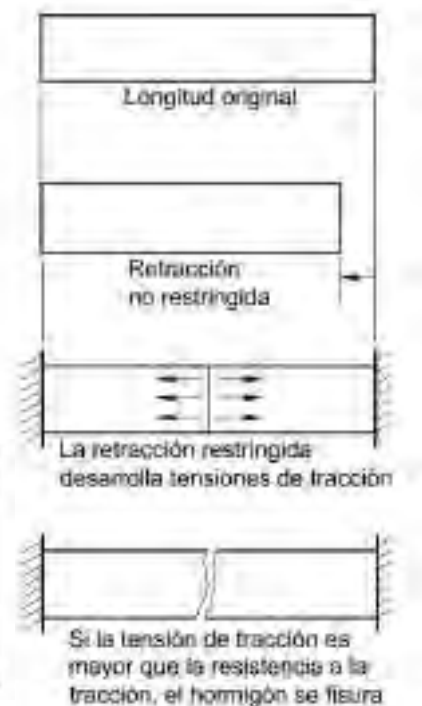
fisuración de retracción en losas (Perez Valcárcel, 2000)
